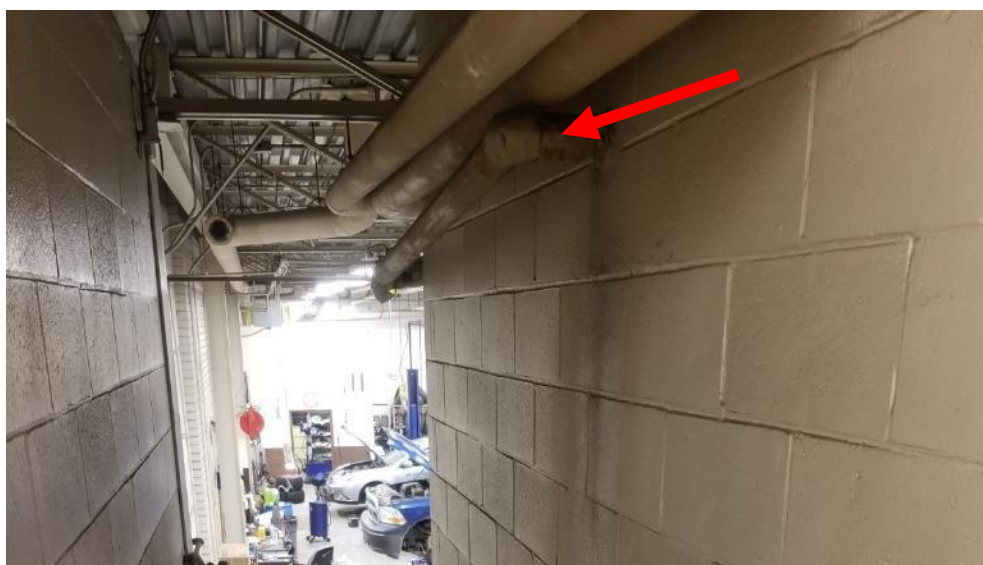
Rez-de-chaussée, aire de service, cage d'escalier, un raccord dans un état passable.
